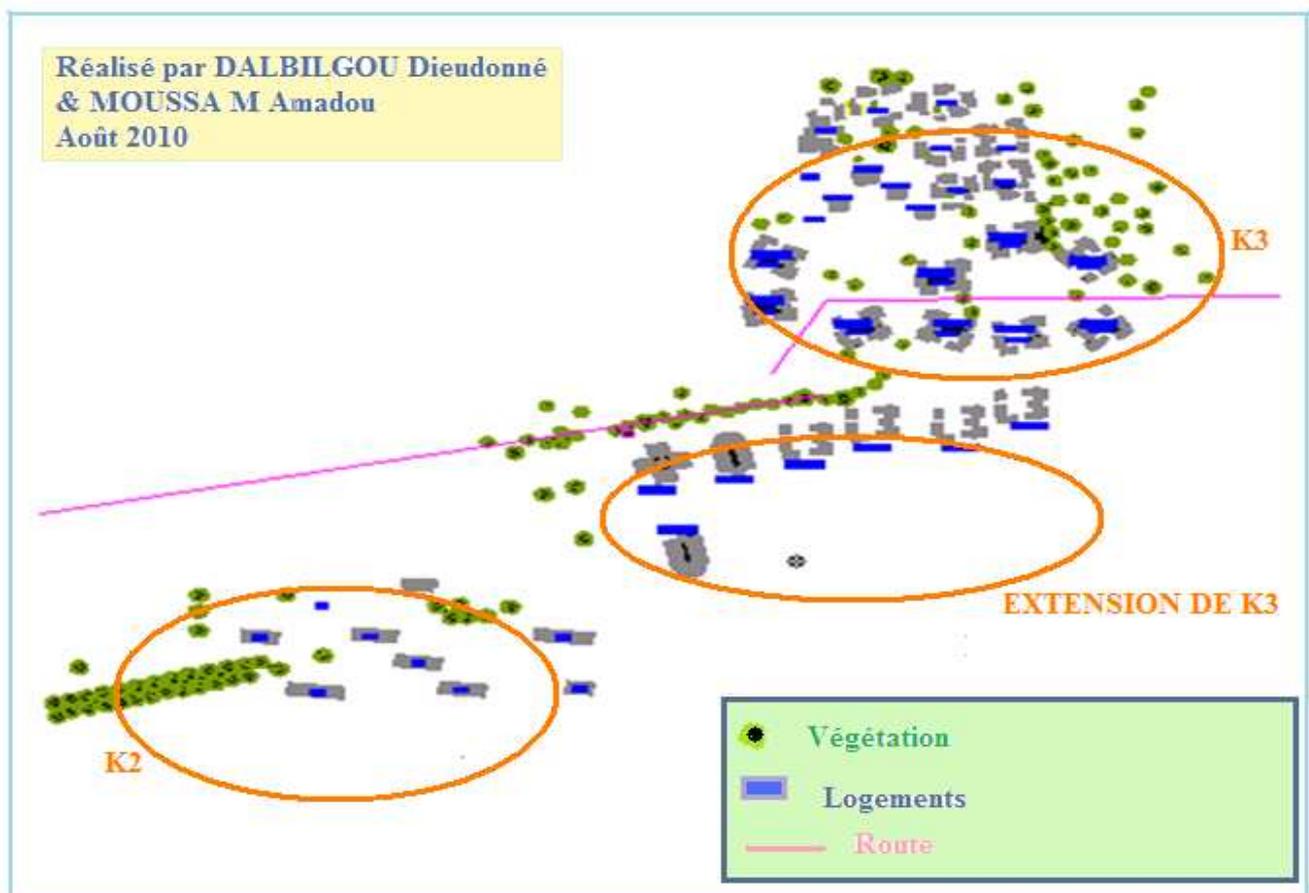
Plan de masse des zones K2 et K3 du site de Kamboinsé
